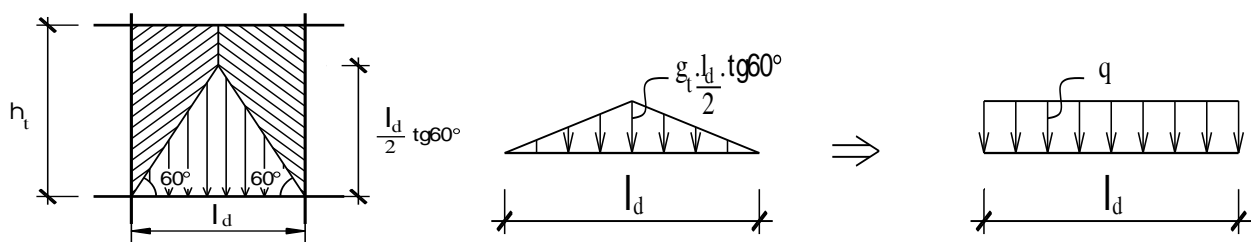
Sơ đồ truyền tải trọng tường đặc vào dầm (dạng hình thang).
